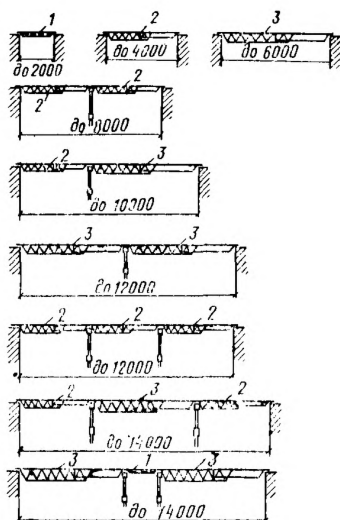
Схема установки раздвижных ригелей конструкции ЦНИИОМТП для опирания опалубки плит перекрытий различных пролетов
